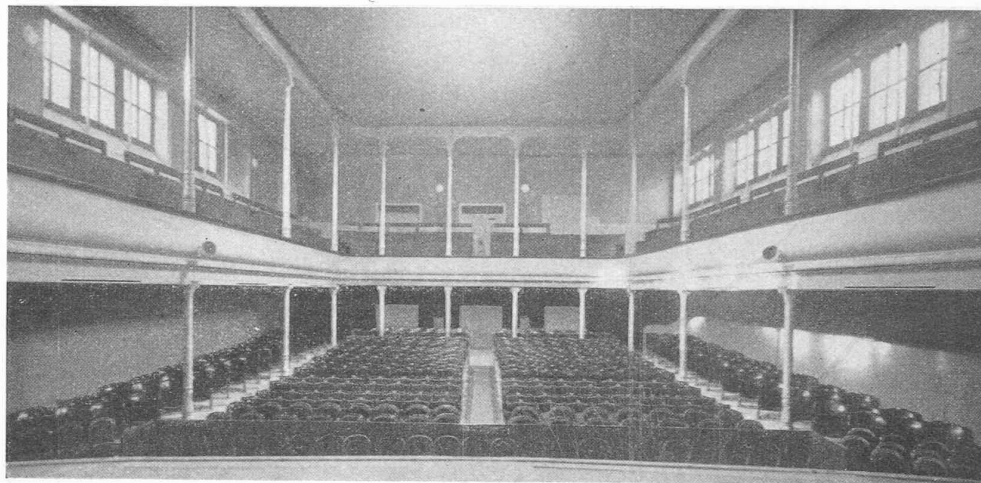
Salle du théâtre de Vevey. Les bouches de soufflage sont installées sous les galeries.
